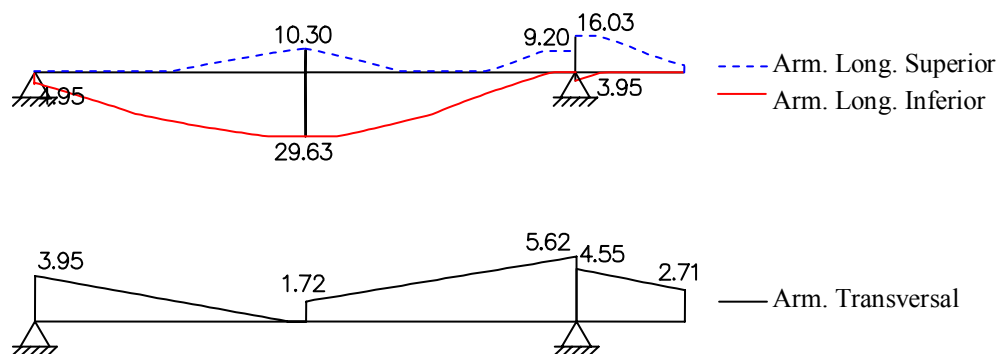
Diagramas de armadura necessária para a viga do Exemplo 3.
